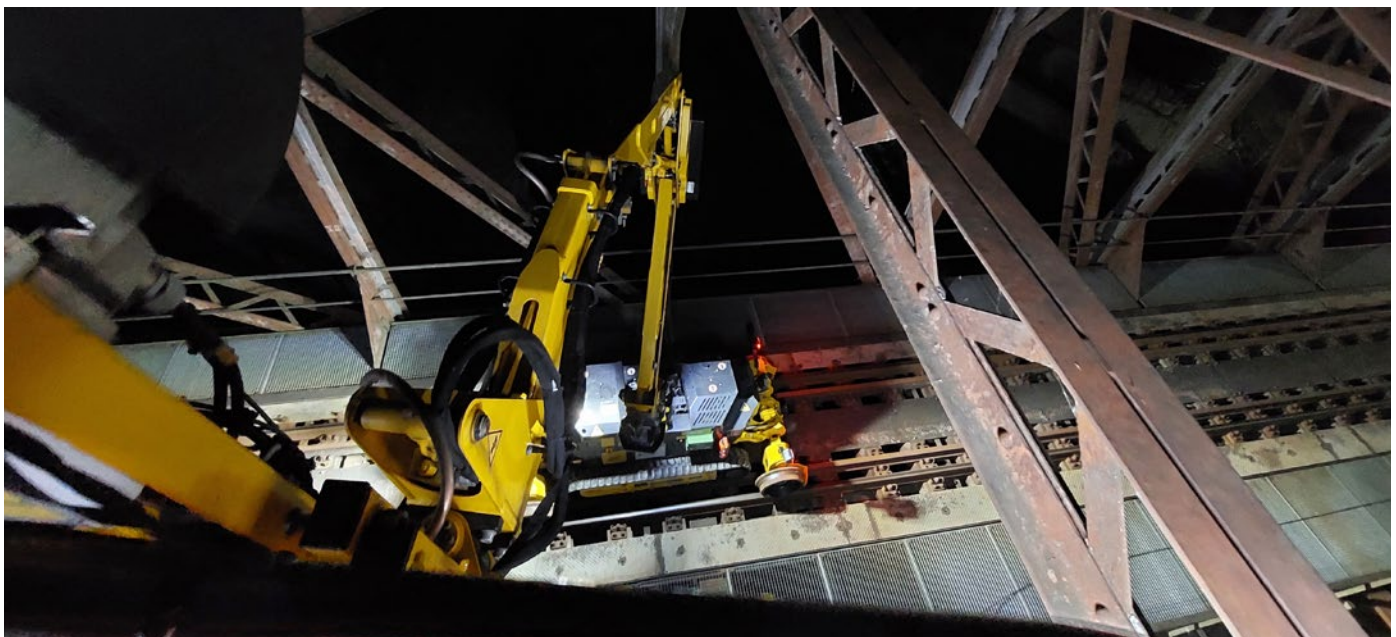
Mithilfe einer detaillierten handnahen Untersuchung und einem Bauwerksmonitoring wurde das Tragwerksmodell der Eisenbahnüberführung Unterreichenbach an das reale Tragverhalten der Brücke angepasst.
